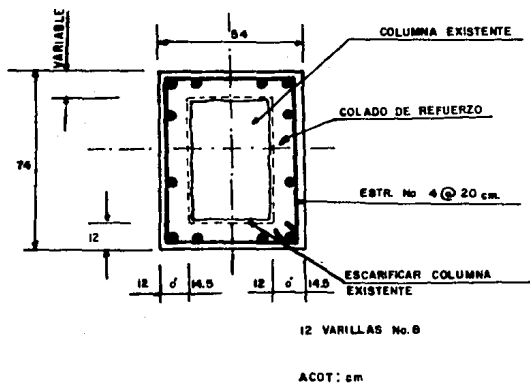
REFUERZO TÍPICO EN COLUMNAS
